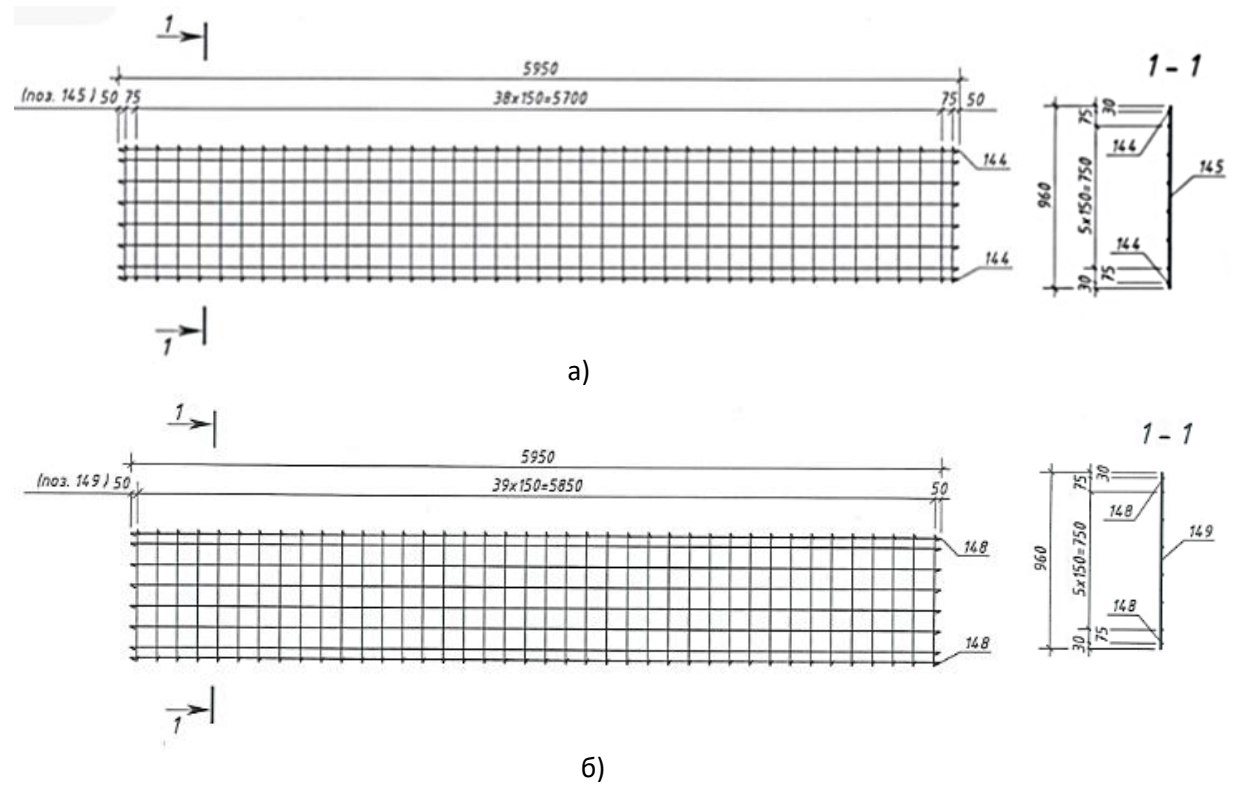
Арматурні сітки для армування тришарової стінової панелі:
